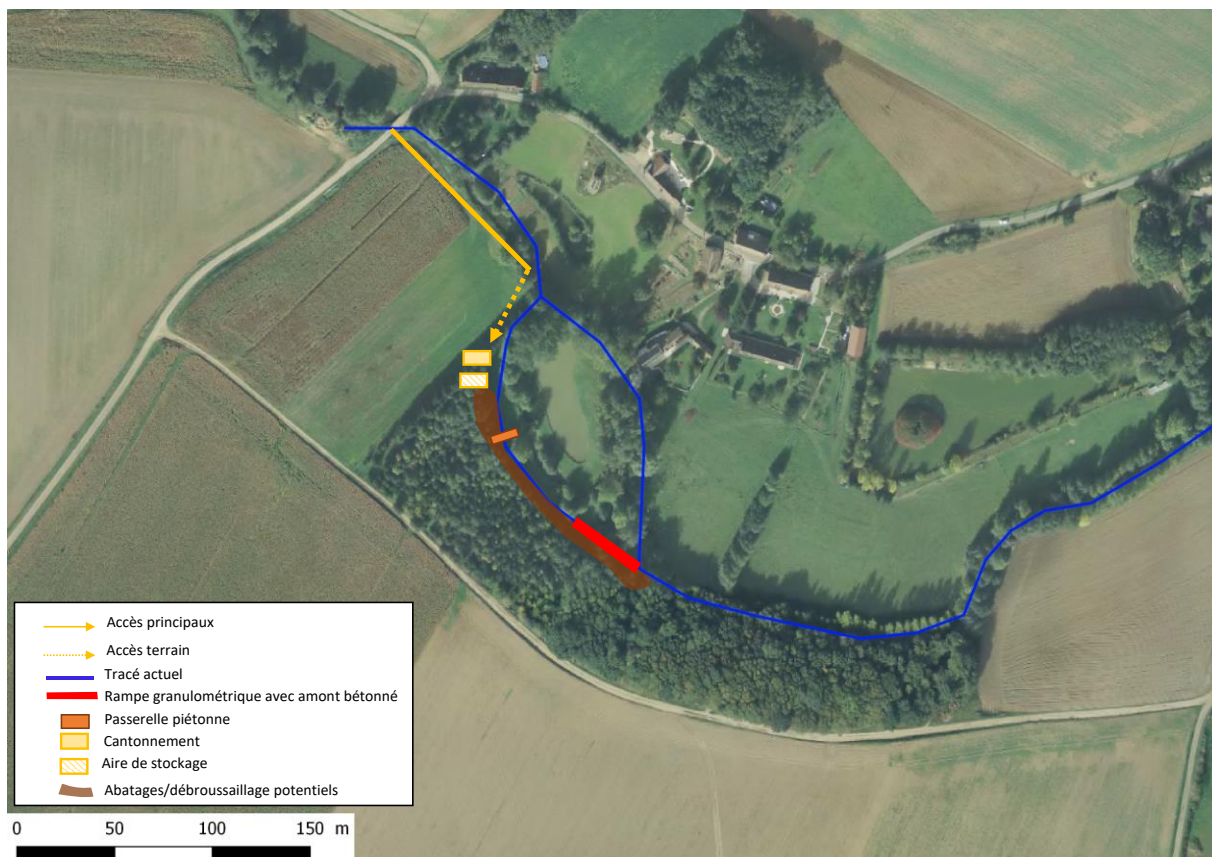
Accès et installations de chantier sur le site du moulin Bondon
